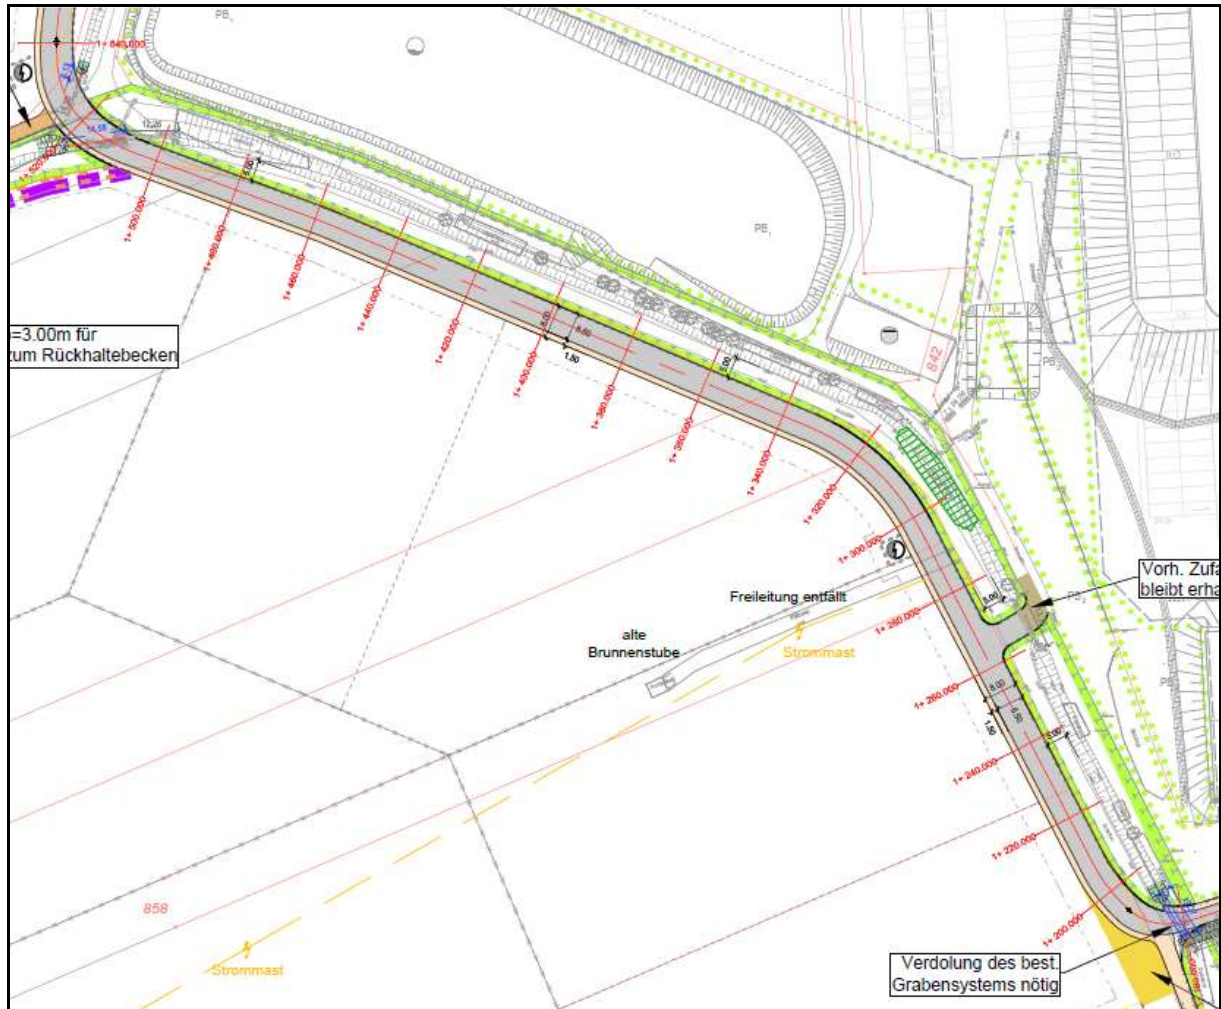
Ausschnitt der Entwurfsplanung Hapbach (aus Anlage 1) südlich des bestehenden RRB / PB1) im Vorhabenbereich BP Wammesfeld (Weber-Ingenieure).
